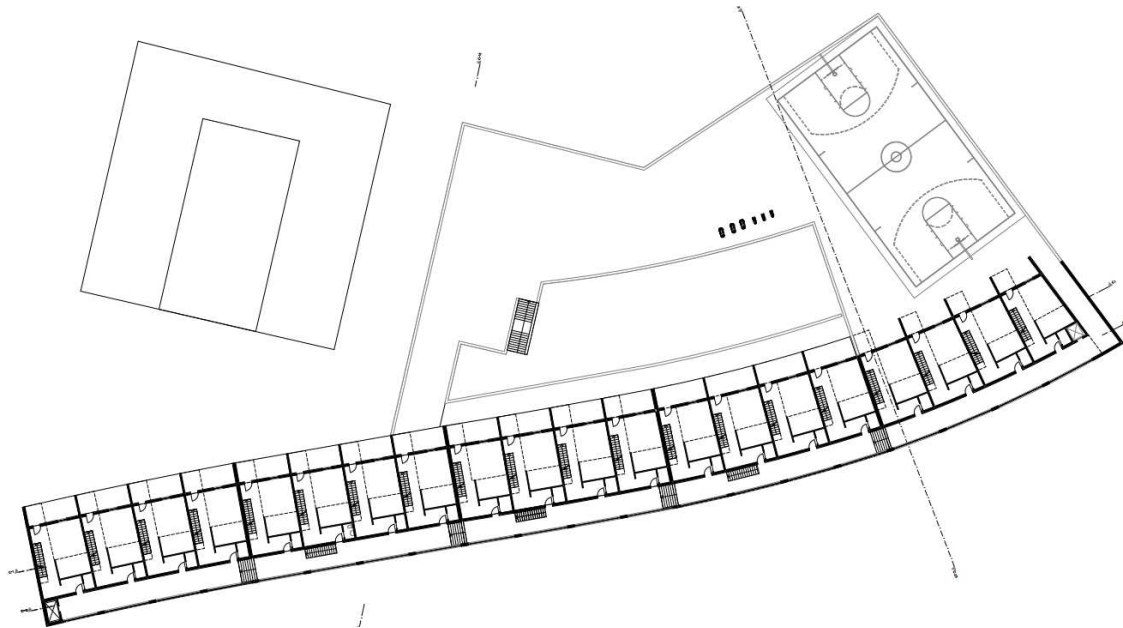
Evolução da proposta_1º andar_27/06/2014
